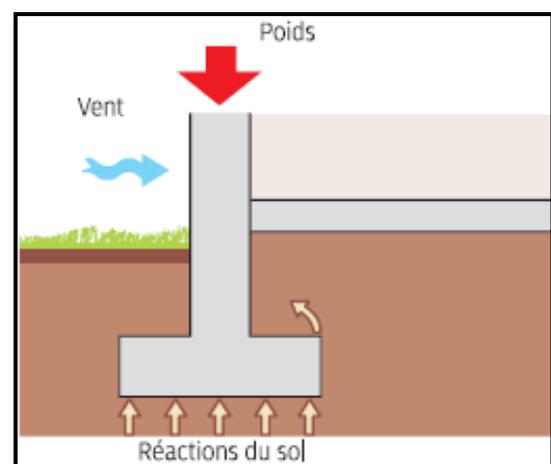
image représentante d'une fondation/ Source: Fondations-APTE-ASSO.ORG.
